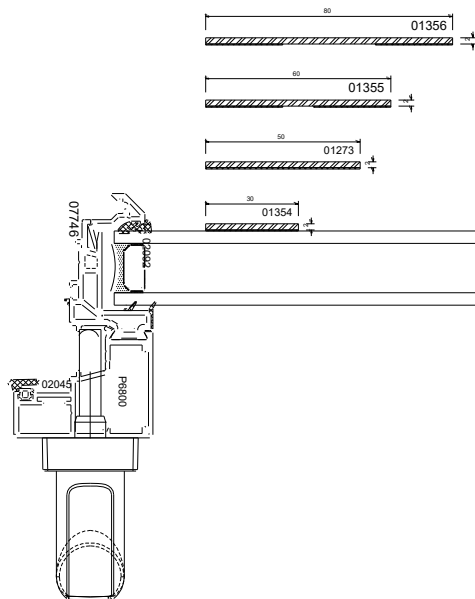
DETAIL DE MISE EN PLACE DU CACHE DRAINAGE
